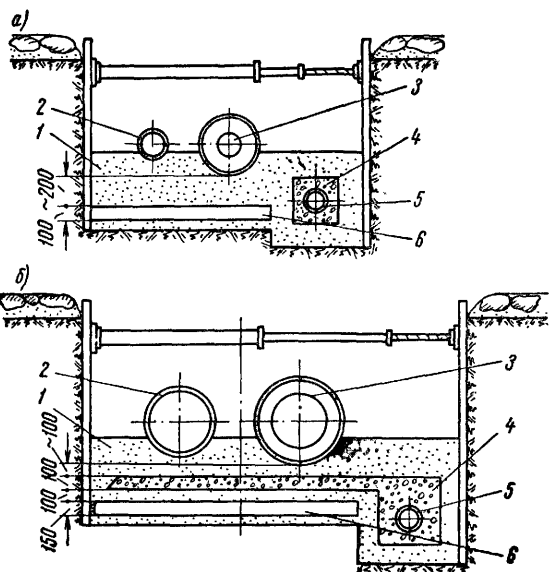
Сечение бесканальной прокладки в мокрых слабых грунтах
